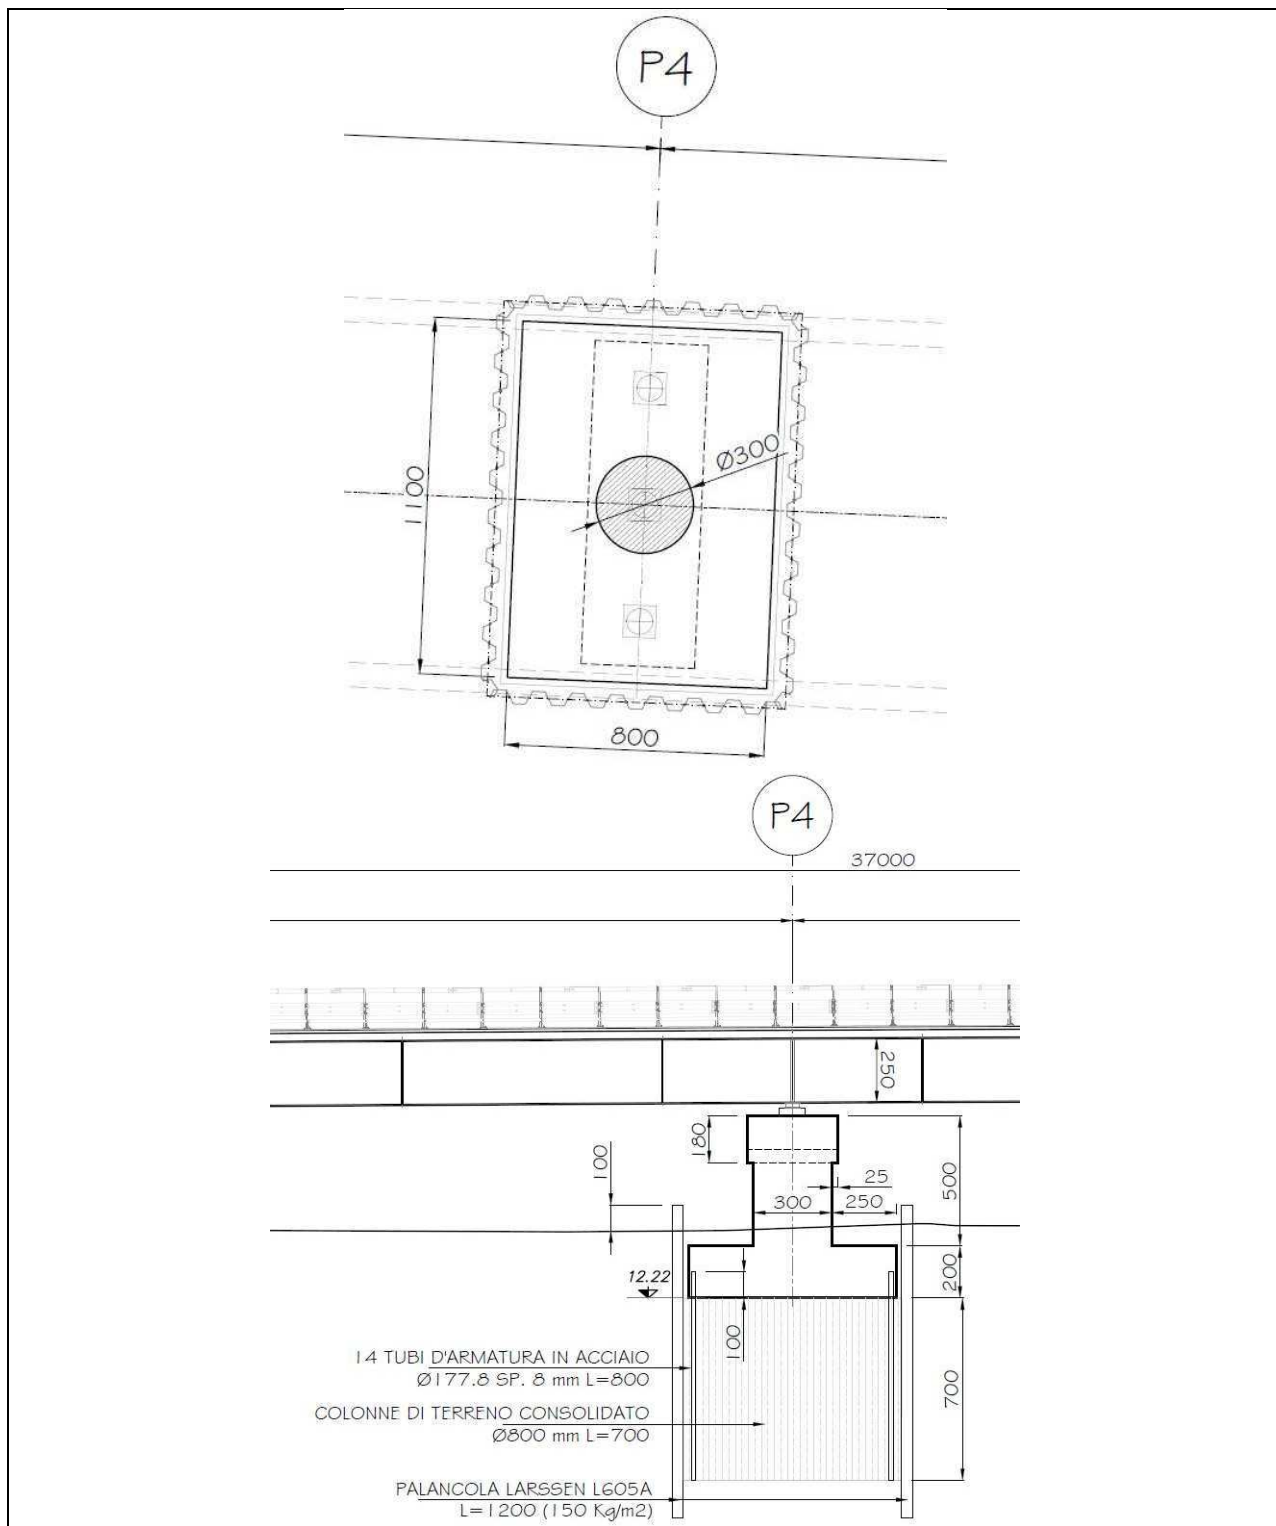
Pila4 - Pianta Fondazioni e Sezione
